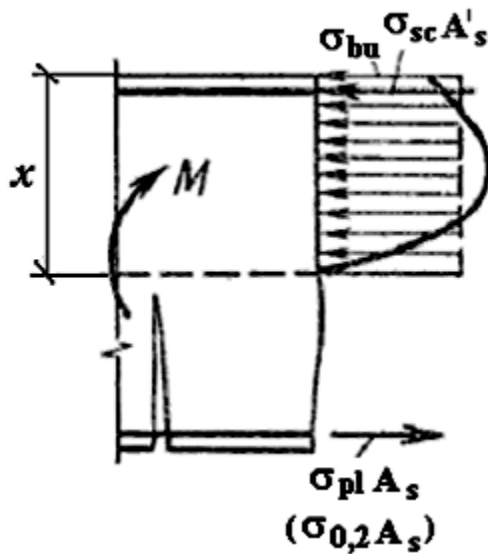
Стадія III напружено-деформованого стану. Випадок 1. (Руйнування по арматурі).
